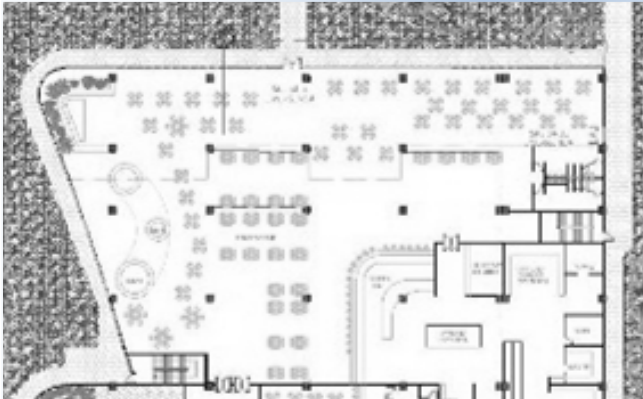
Restaurante de Planta Baja +0.30 Autora: Cáceres (2017).
